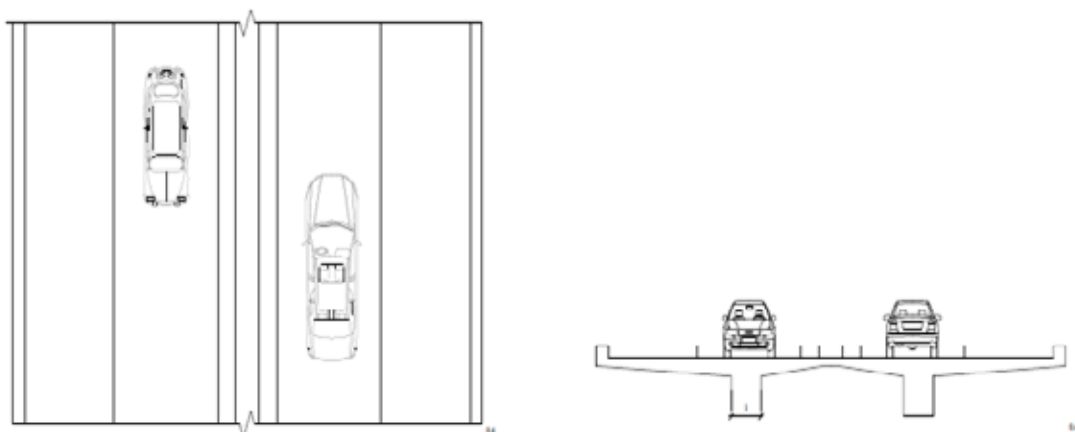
Planta y Sección del viaducto en Patanemo propuesto
